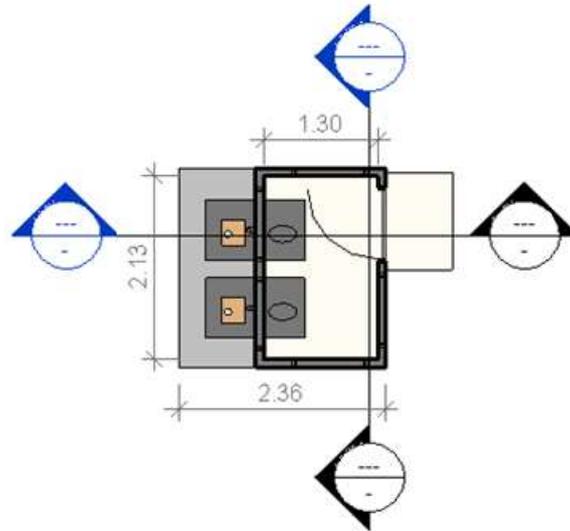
Planta baixa do abrigo ao *Bason* (Autora).
